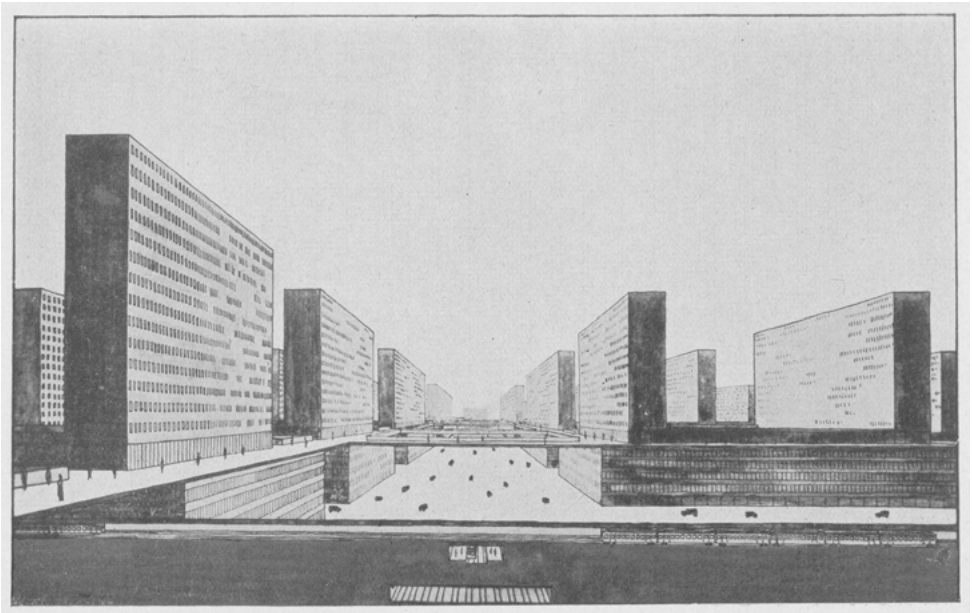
Schema einer Hochhausstadt, Nord-Südstraße
